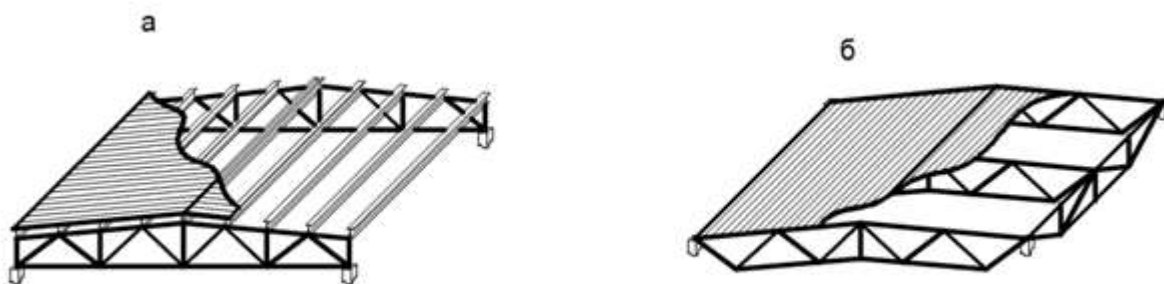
Конструктивные варианты покрытий со стальным профилированным листом: а- прогонное покрытие; б- беспрогонное покрытие;
